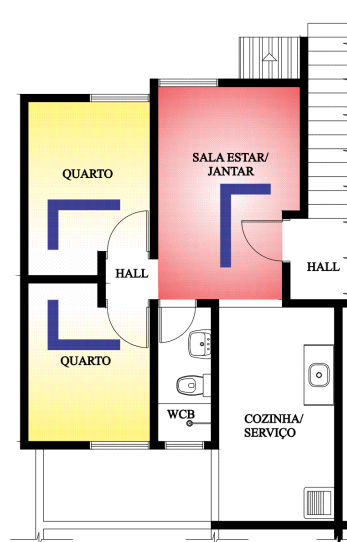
Planta Baixa Pav. Tipo do Residencial Ouro Preto I (sem escala)
